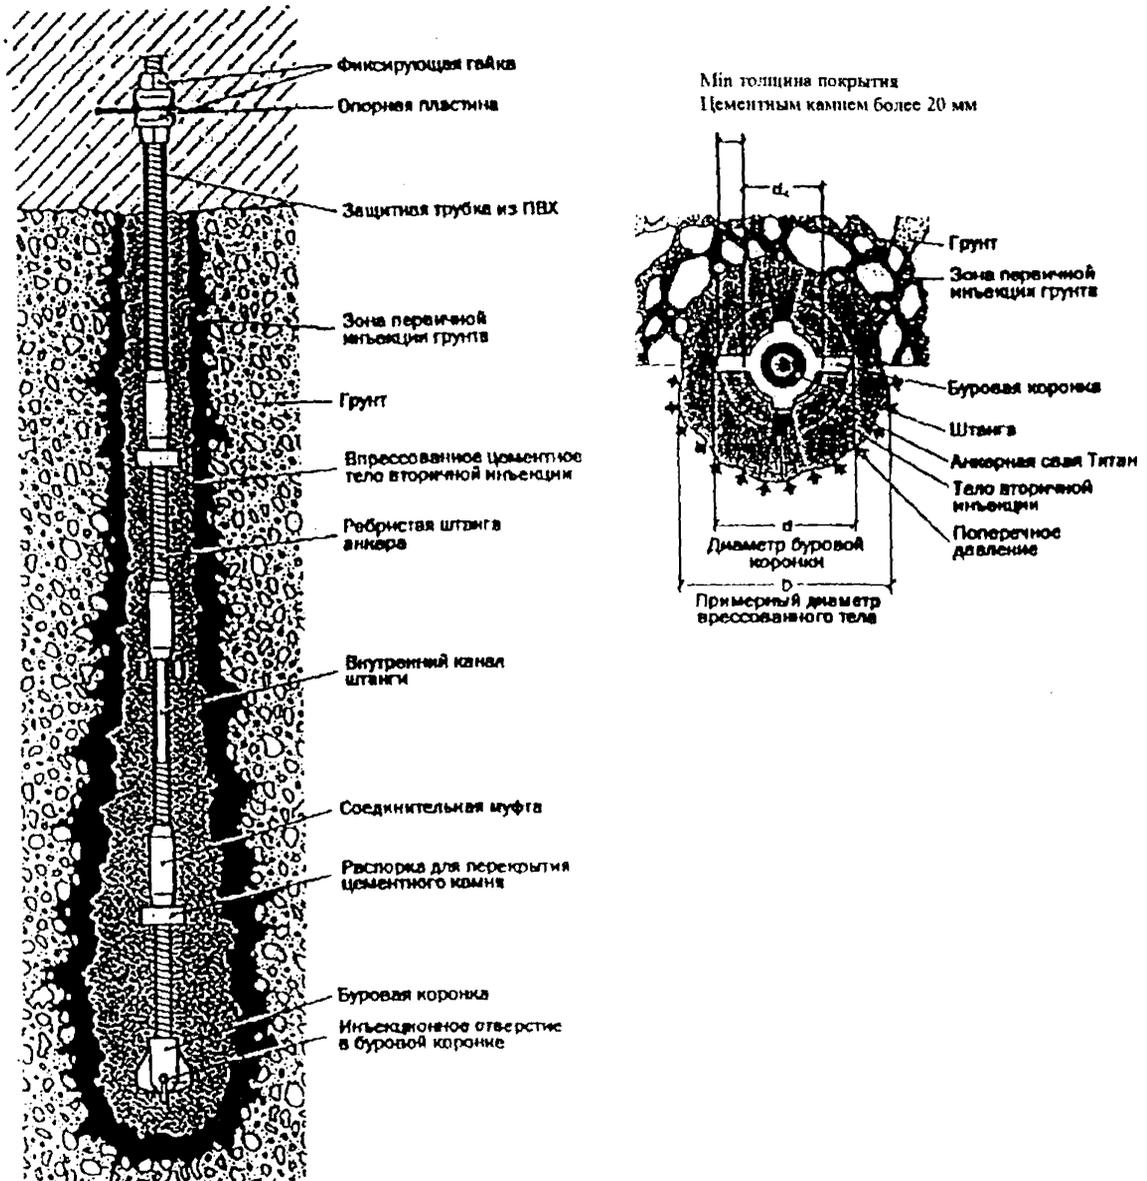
Конструкция анкера (свай) из трубчатых штанг в грунте
